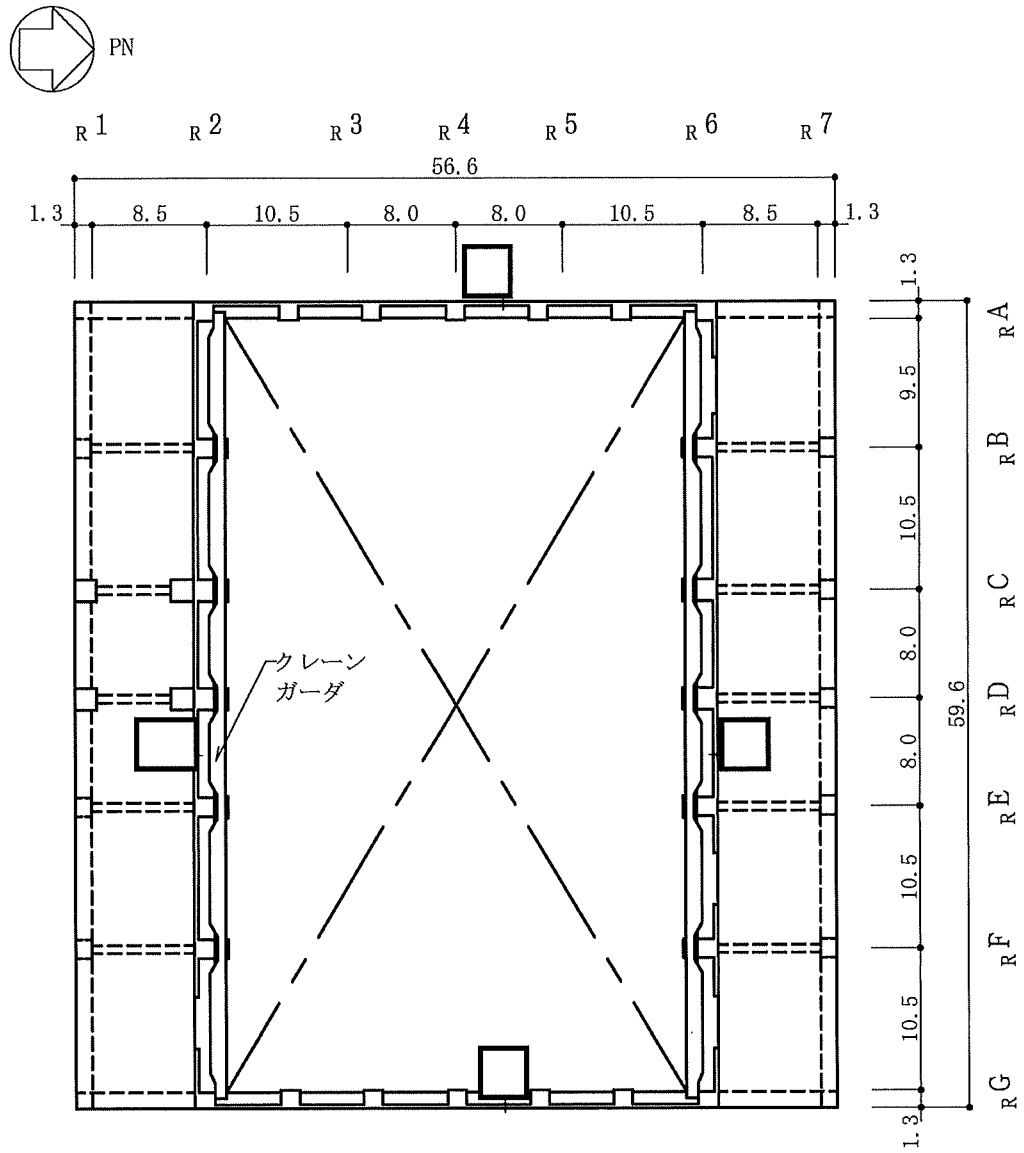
原子炉建屋の概略平面図 (CRF, T. M. S. L. 38.2m) (8/9) (単位 : m)
